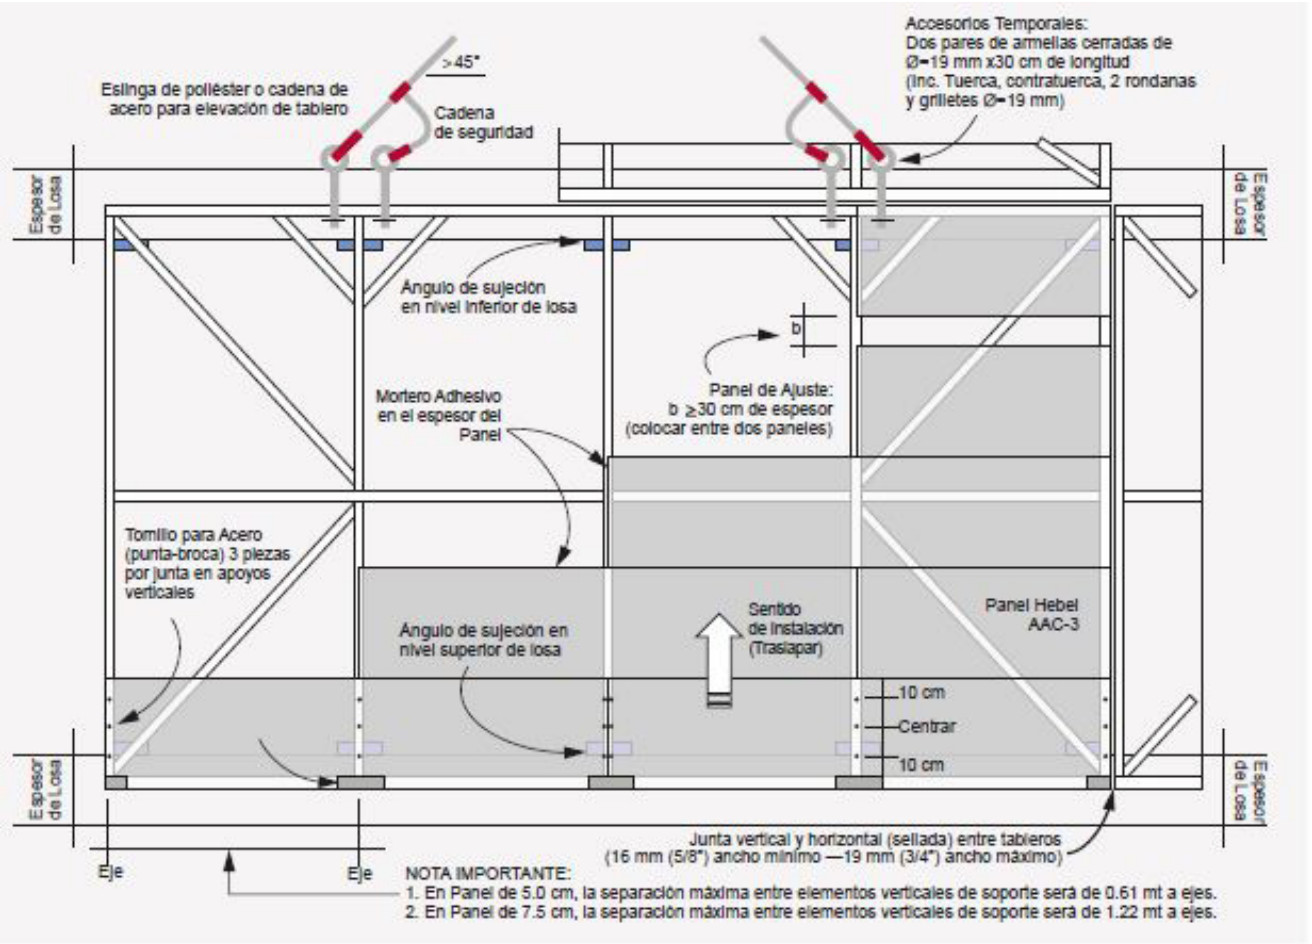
Detalles constructivos para una correcta instalación del Panel Hebel sobre el bastidor metálico para muros de fachada (no cargadores).
